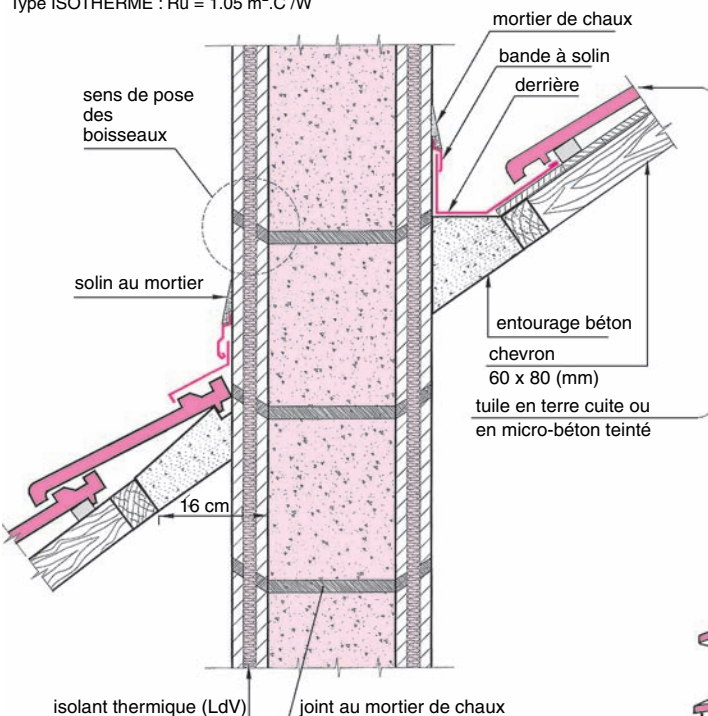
Détail d'entourage réglementaire du conduit et raccords d'étanchéité suivant la pente du toit
